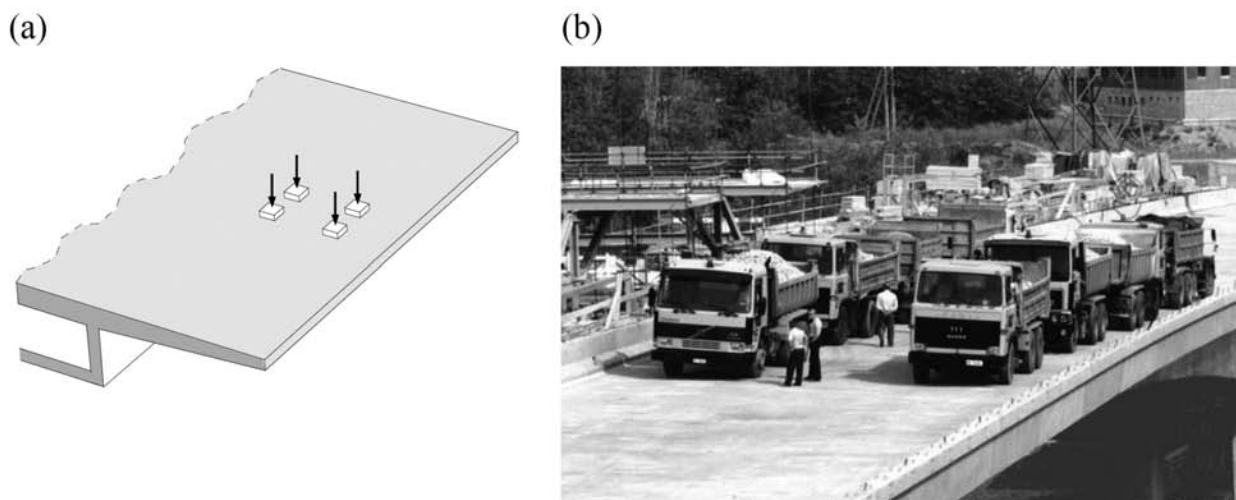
Losa de un puente cajón sometida a la acción de cargas puntuales (carro): (a) esquema estructural; y (b) prueba de carga del puente de Aigues-Vertes (A1, Ginebra, Suiza)
